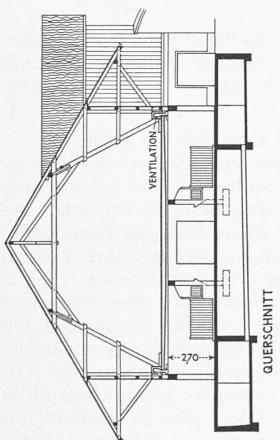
und 19. Scheune Thorberg, Grundriss und Schnitt 1: 400. — Arch. A. WYTTEBACH
